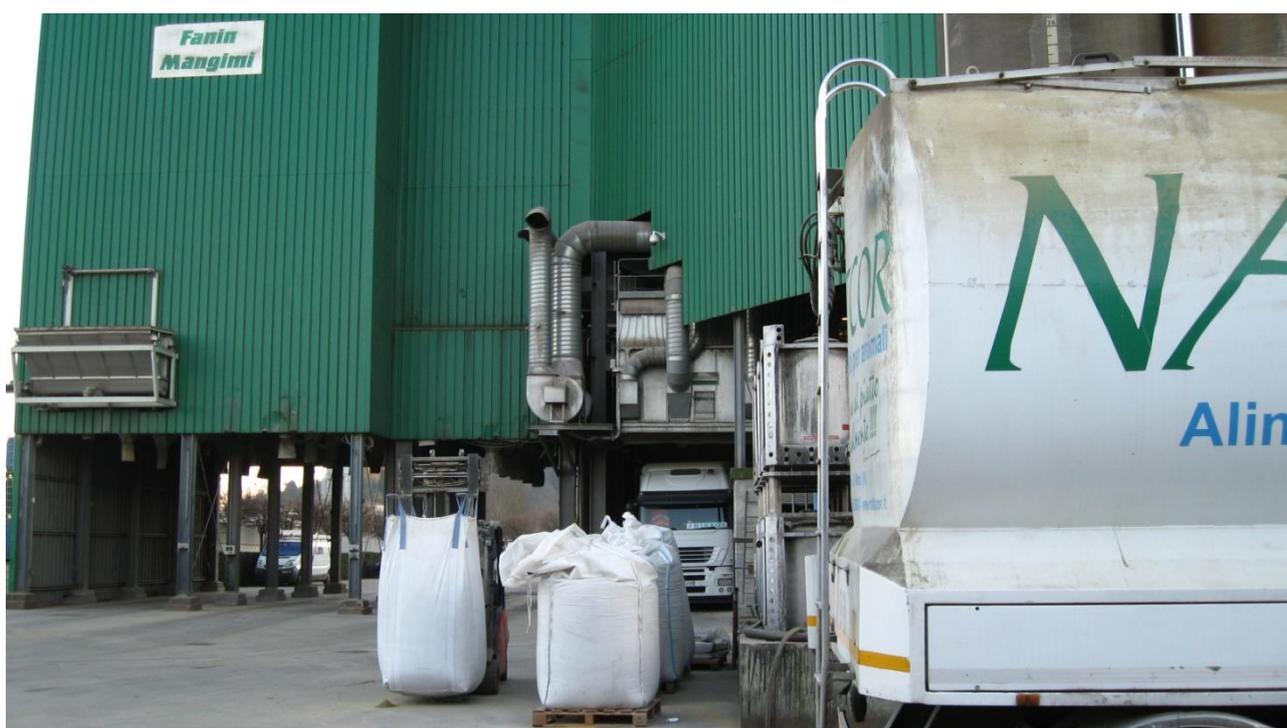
prospetto Nord – porzione di edificio produttivo oggetto di opere di mascheramento.
